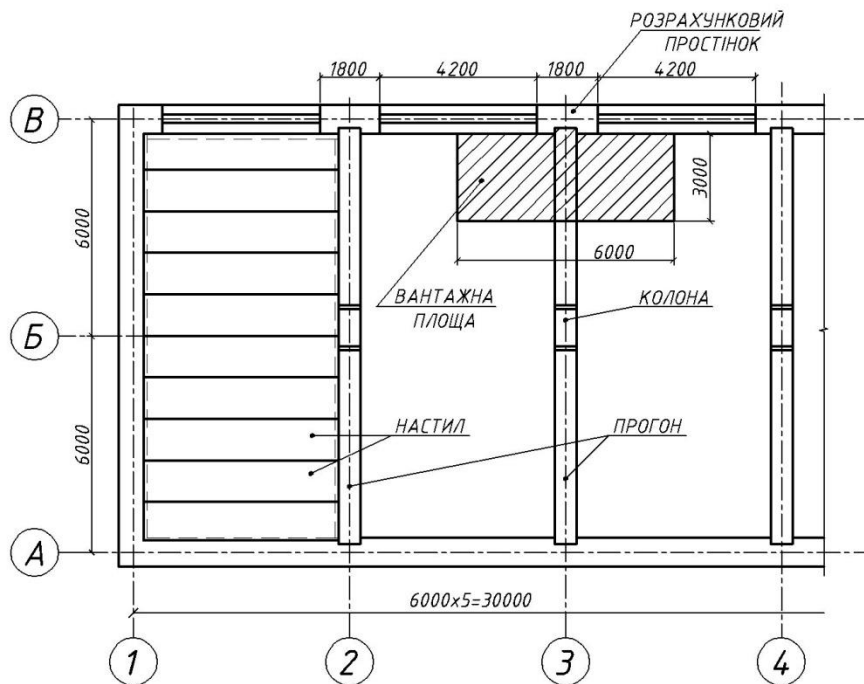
До прикладу 10.6. До збору навантаження на простінок (фрагмент плану будівлі)
